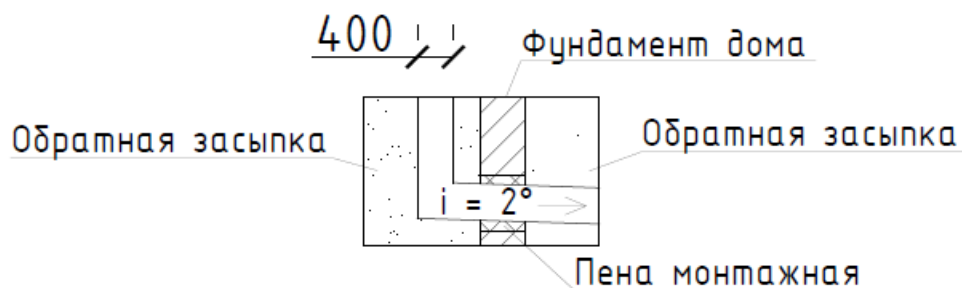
Узел прохода теплогрунтообменника через фундамент здания
